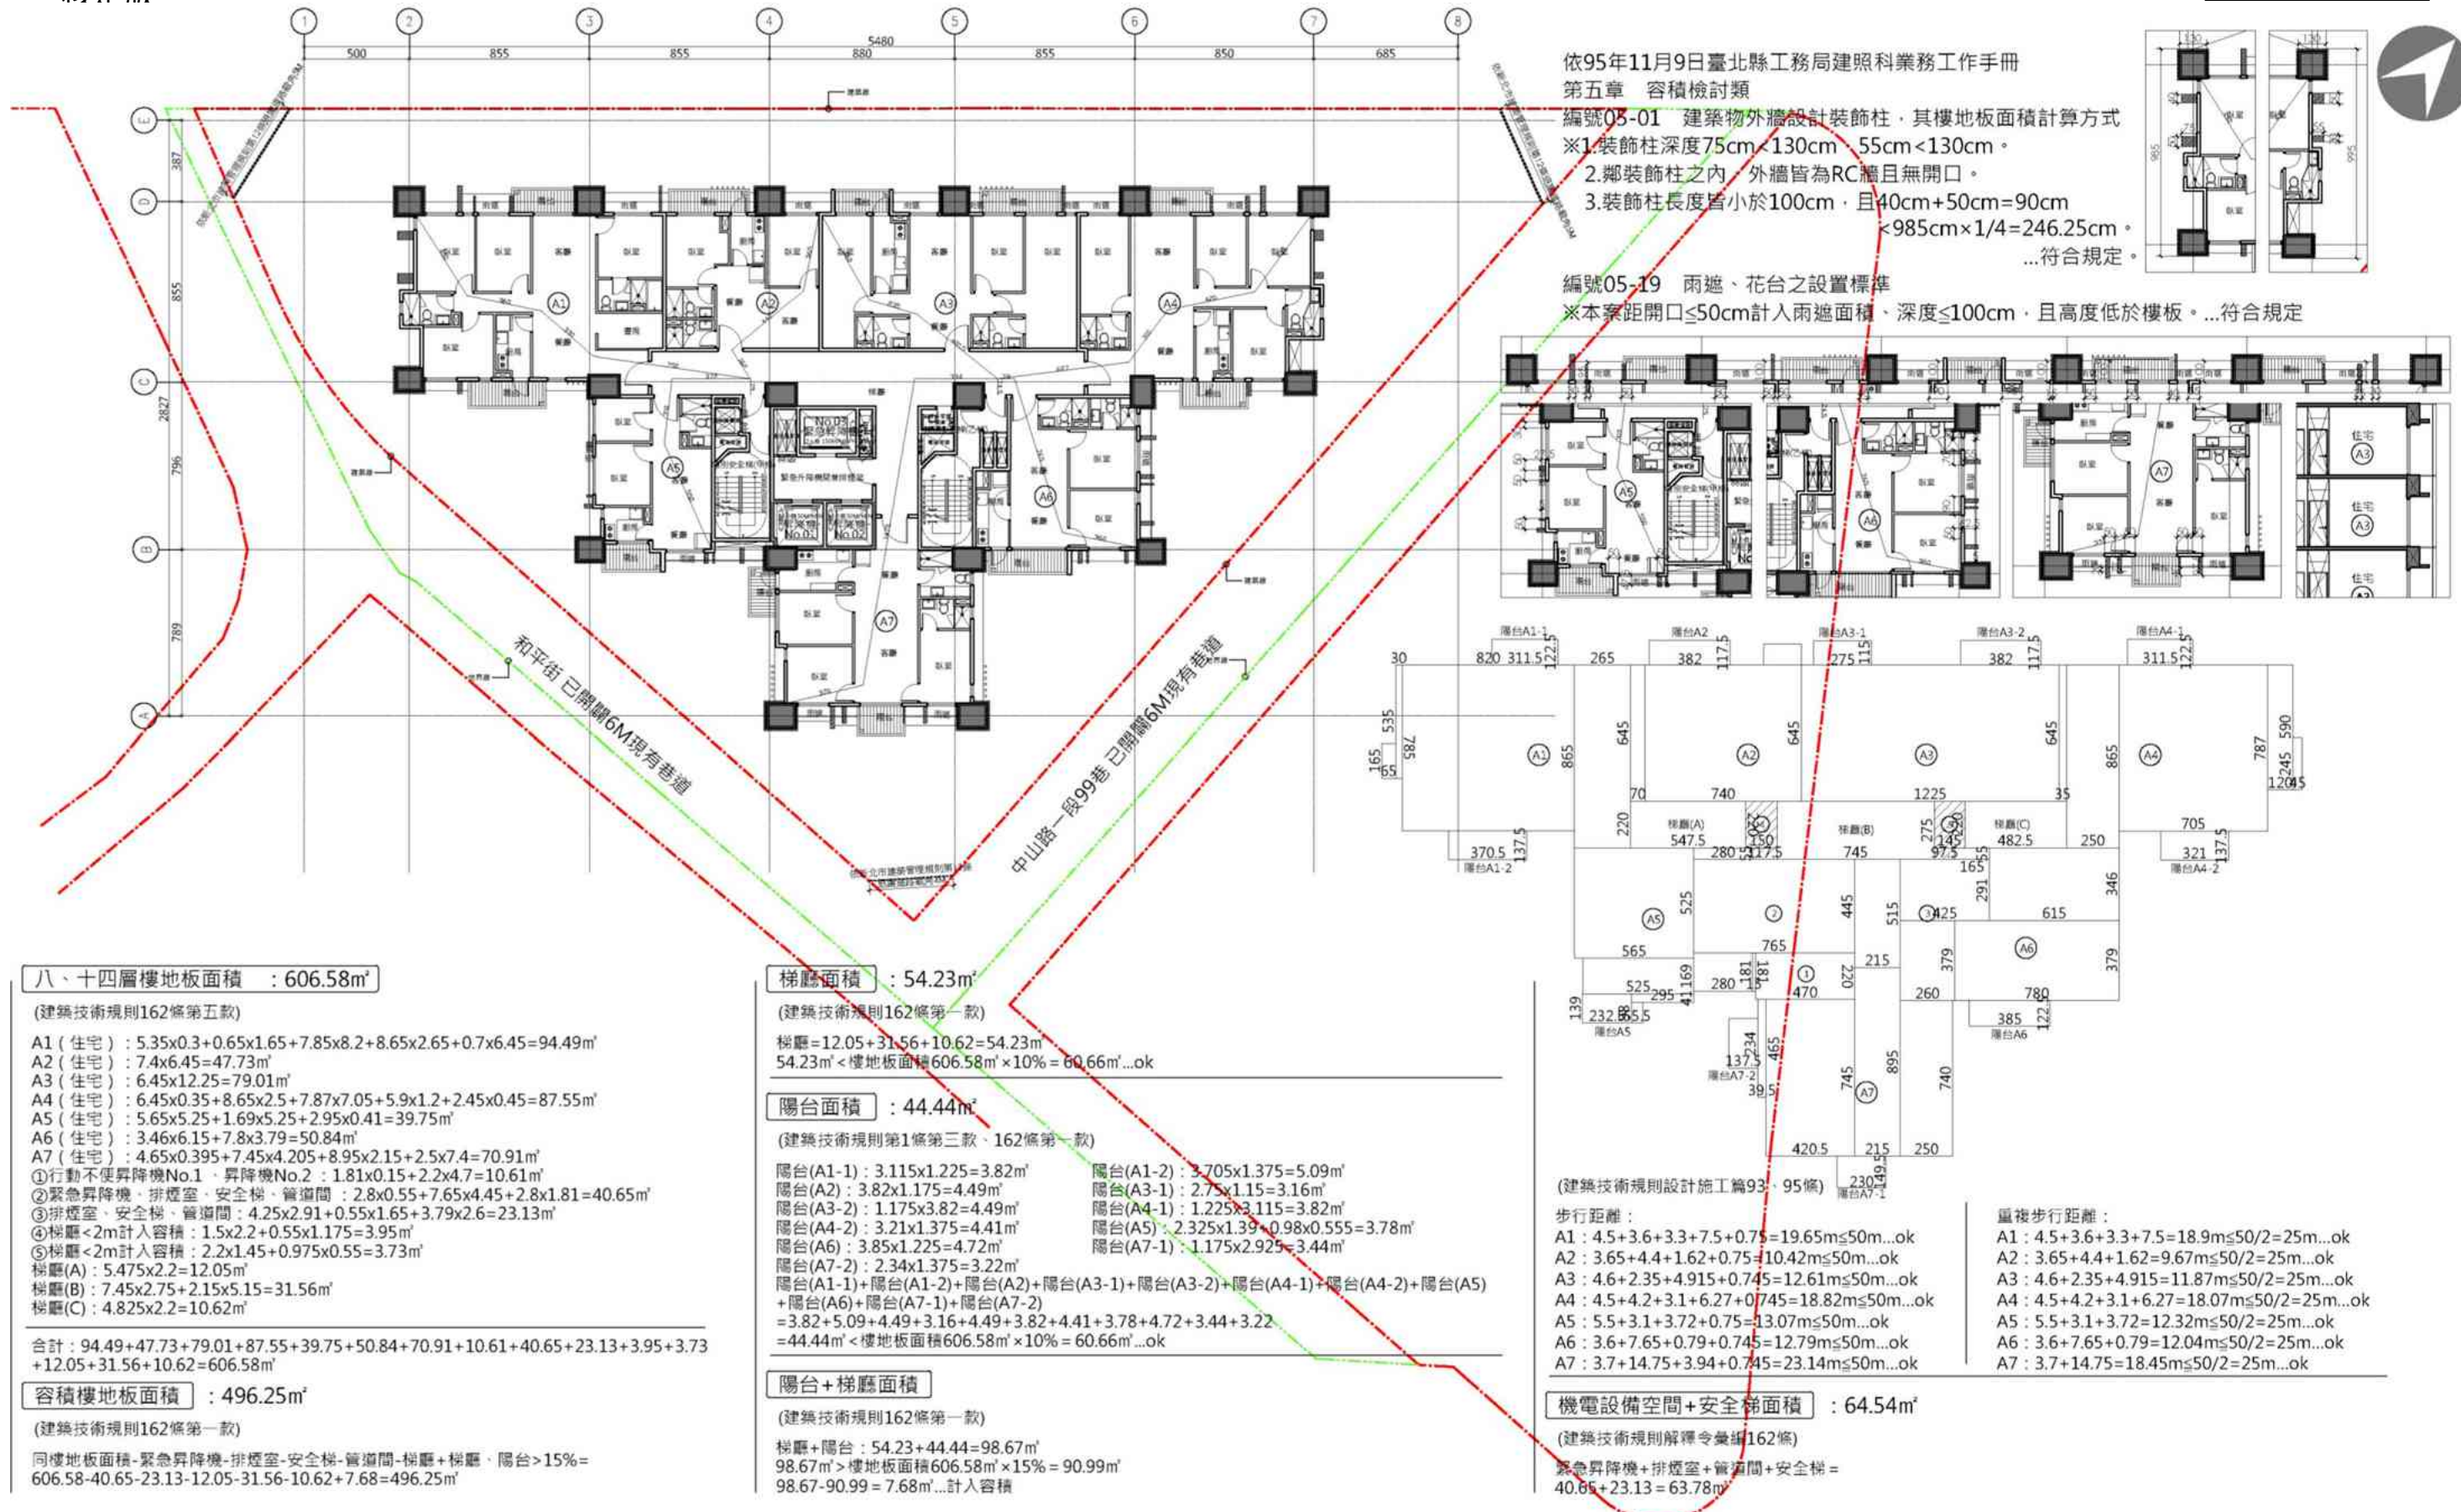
8、14F 平面圖；SCALE A3=1/300
